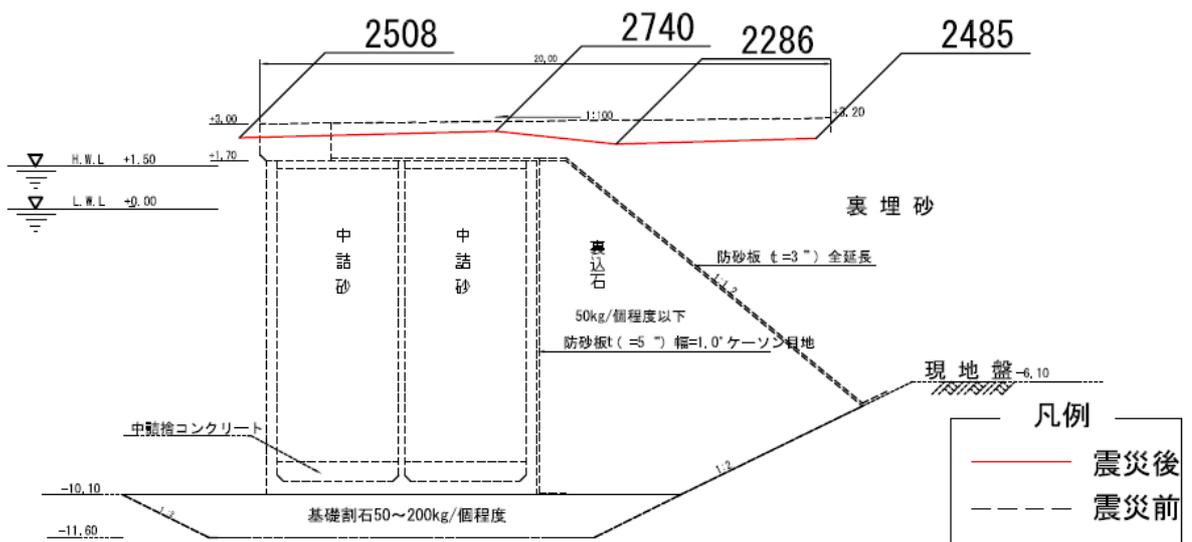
No.2 日立港区_第5ふ頭地区岸壁(-10m)Cの断面図 No.20 (被災前後)
